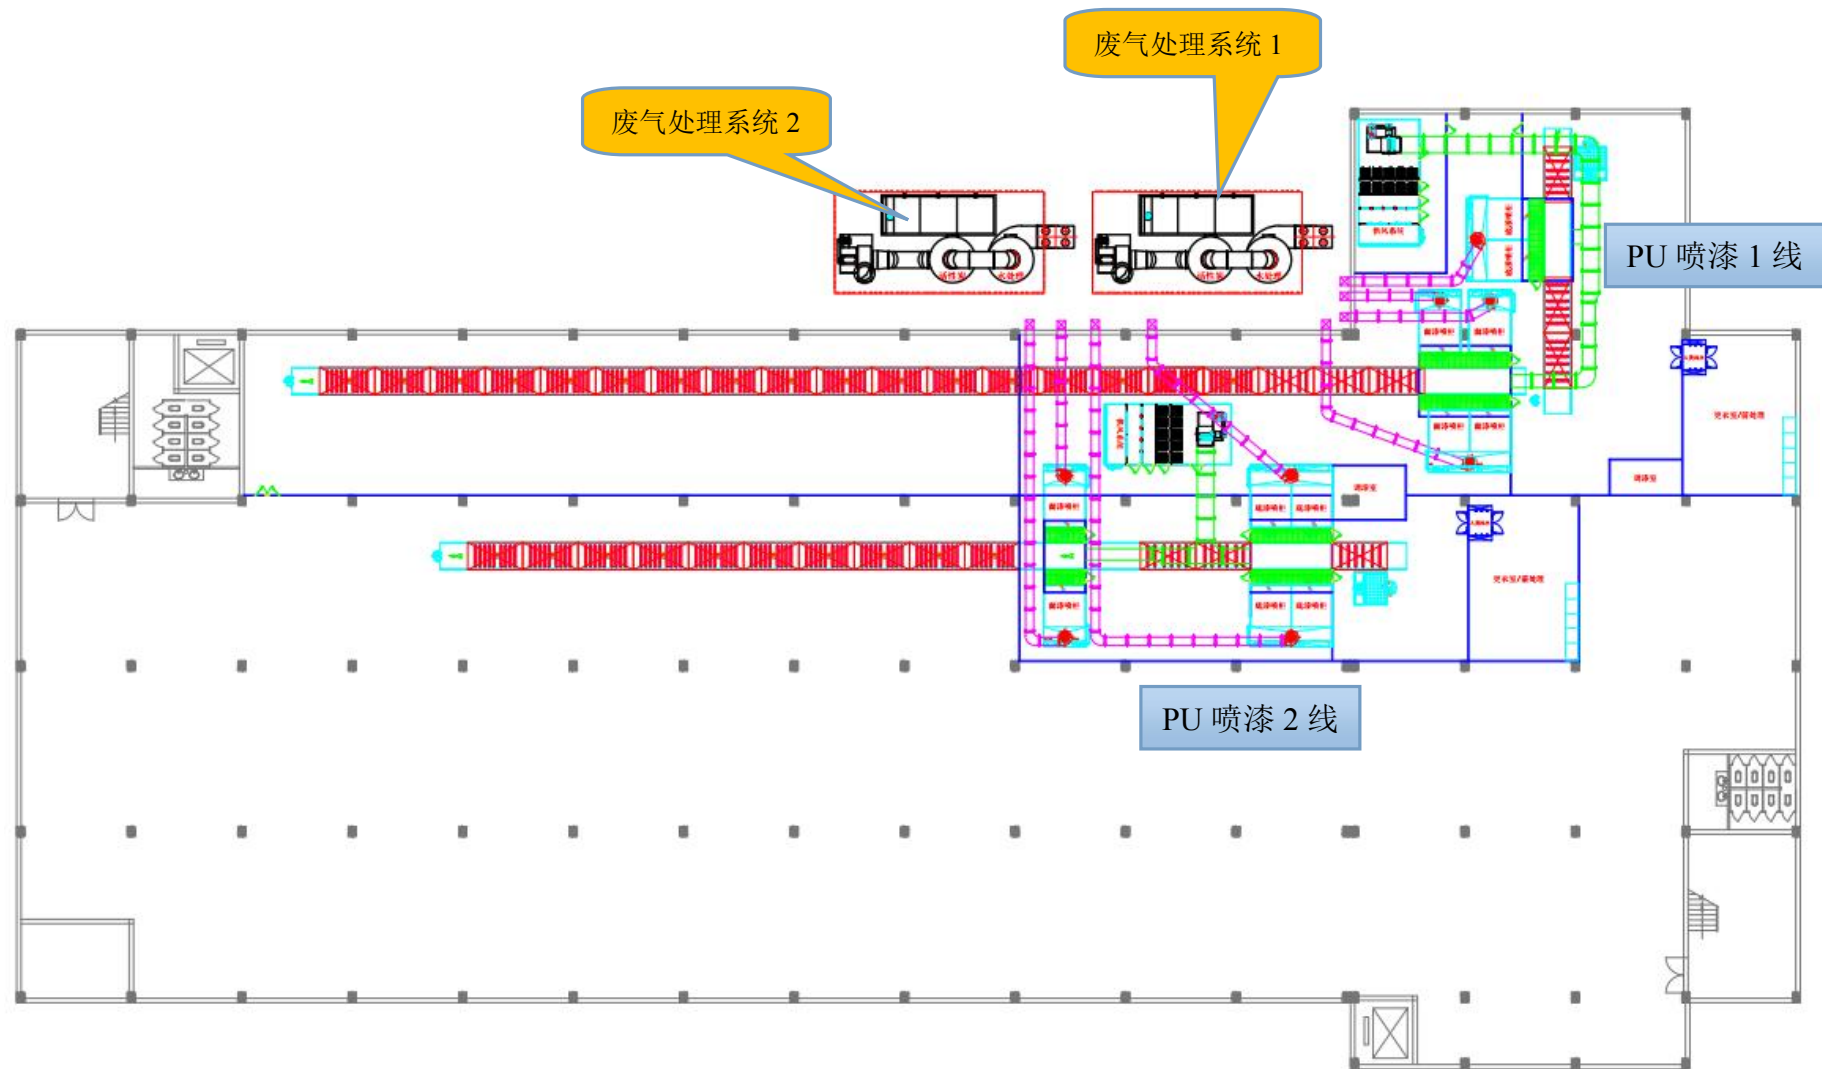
7#厂房 2F 喷漆车间平面布置图
